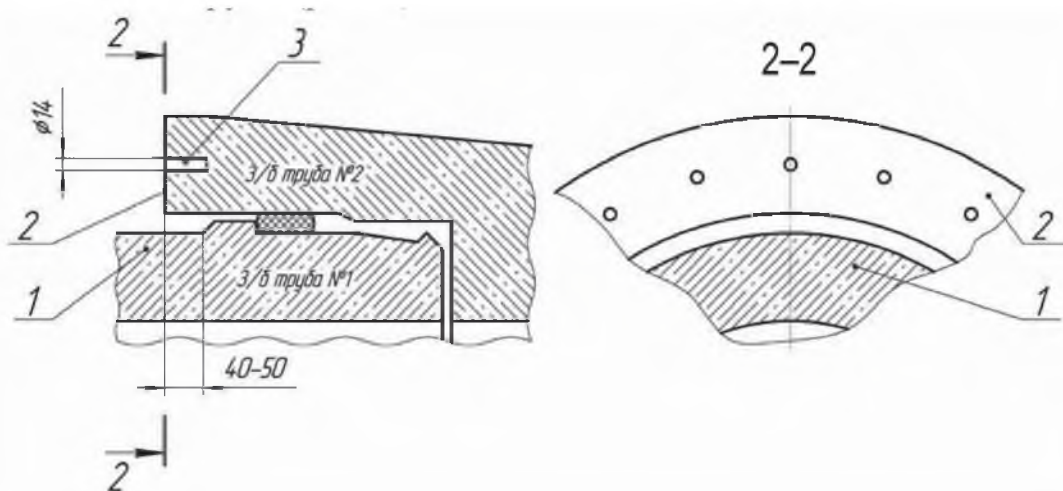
Схема розміщення отворів під шпильки на залізобетонній трубі:
